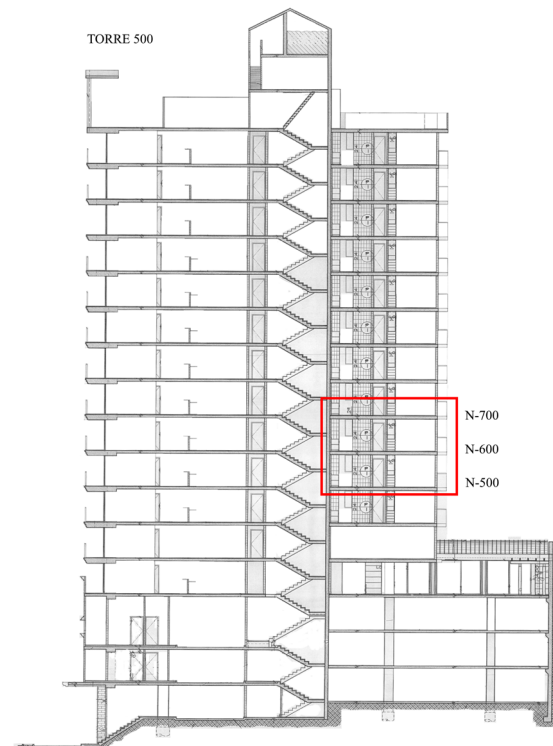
Vista de elevación que muestra los niveles instrumentados.
